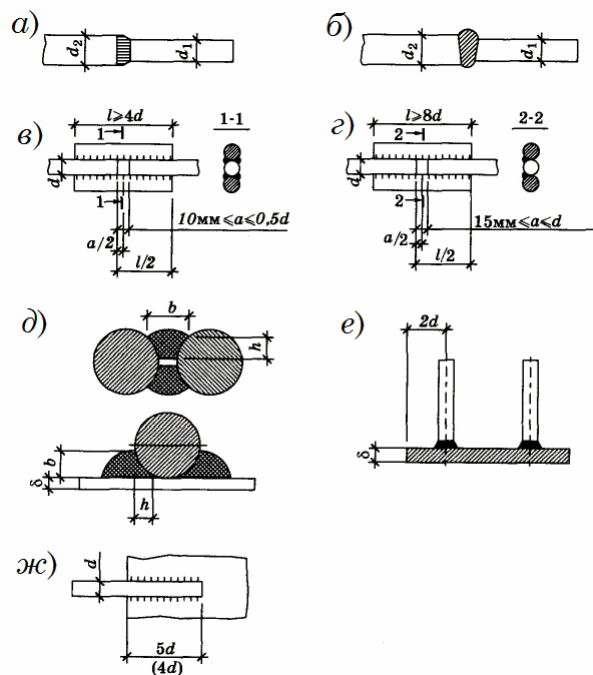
Сварные соединения арматуры: а - контактная электросварка встык; б - дуговая ванная сварка в инвентарной форме; в - дуговая сварка с накладками с четырьмя фланговыми швами; г - то же, с двумя фланговыми швами; д - обозначения размеров сварного шва; е - сварное соединение в тавр стержней с пластиной; ж - сварное соединение внахлестку стержня с пластиной
